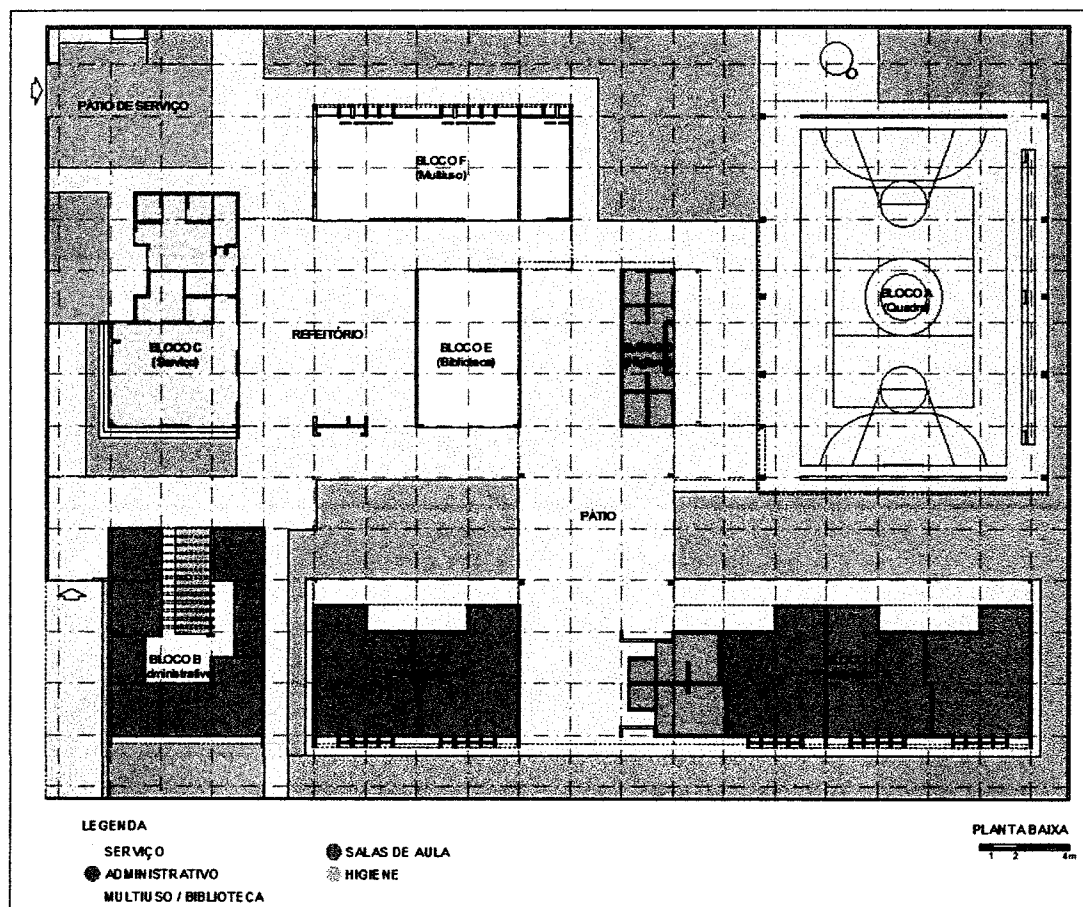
planta baixa de implantação dos blocos – Escola 5 Salas - Térreo
